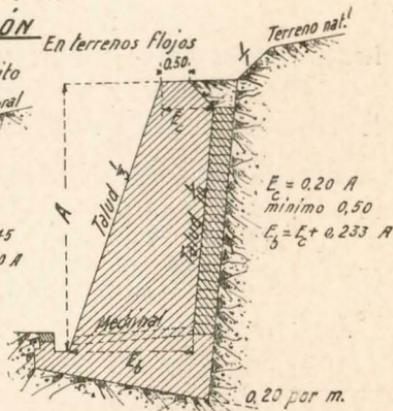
Tipos de muro en el ferrocarril de Tanager a Fez.
